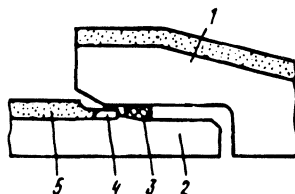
Стыковое соединение раструбных железобетонных предварительно напряженных труб, изготовленных методом центрифугирования:
